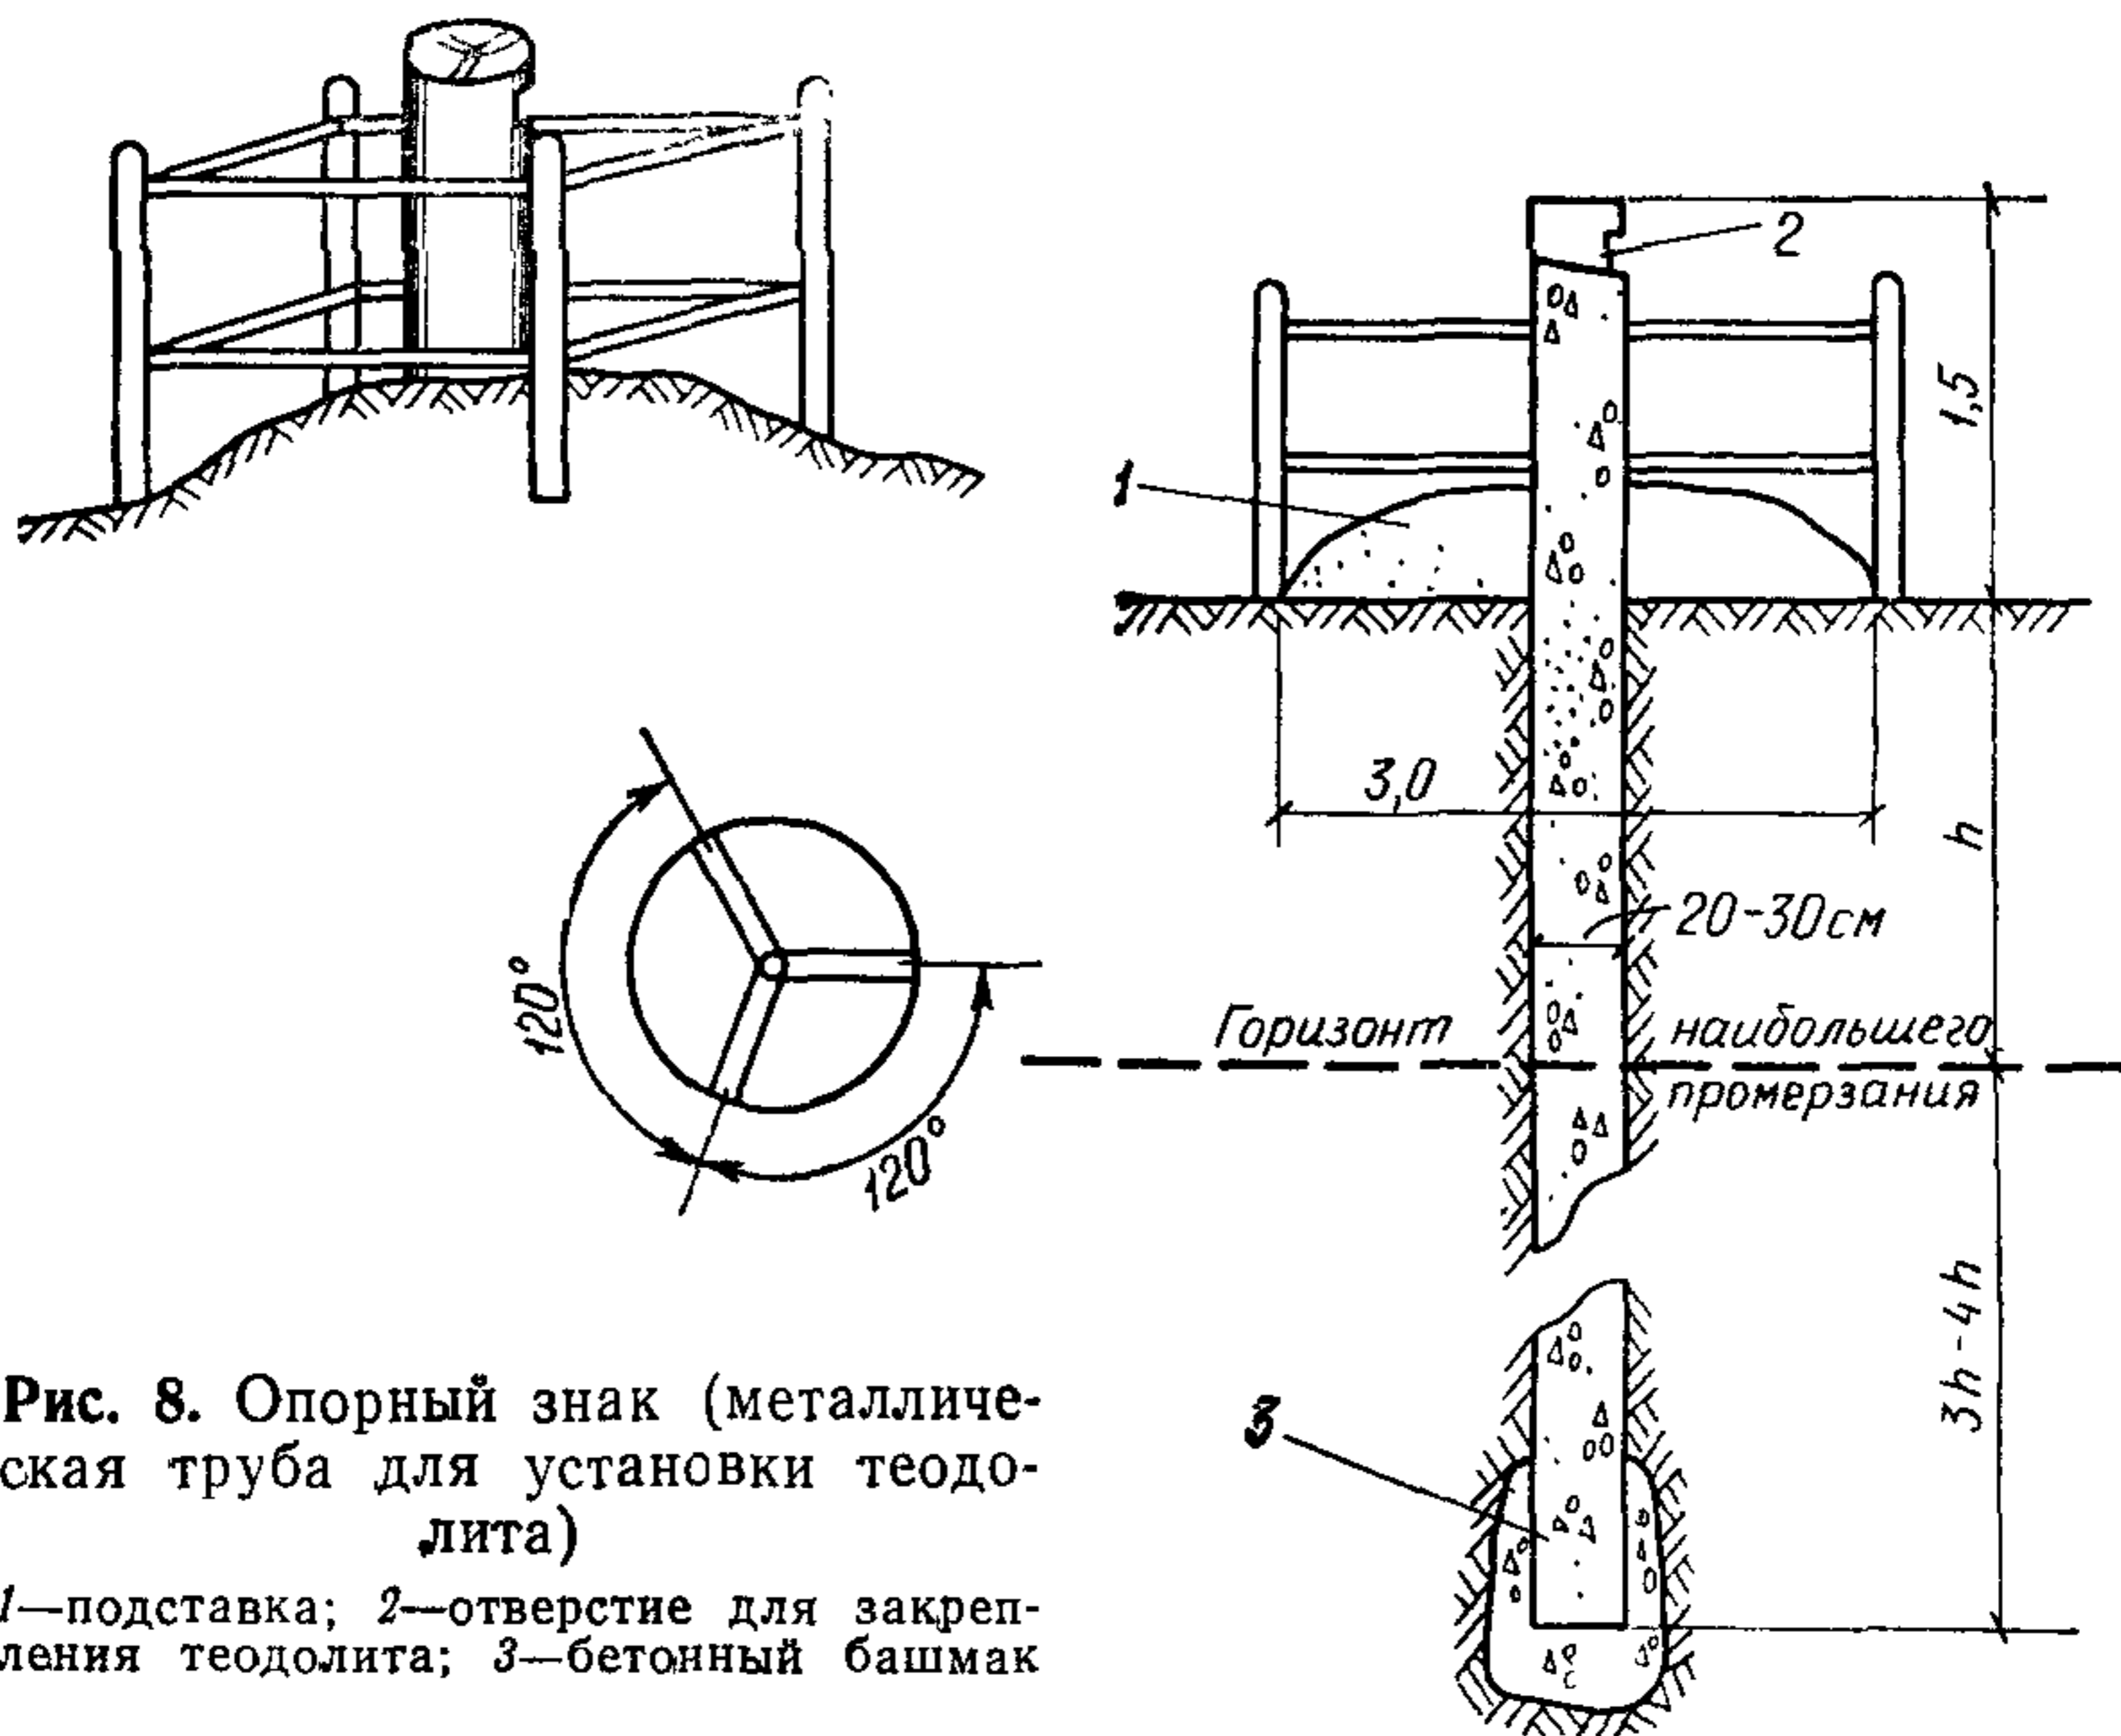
Опорный знак (металлическая труба для установки теодолита)
